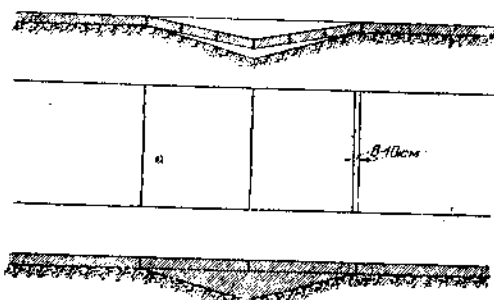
Схема исправления просадки бетонной плиты нагнетанием смеси грунта, цемента и воды.
